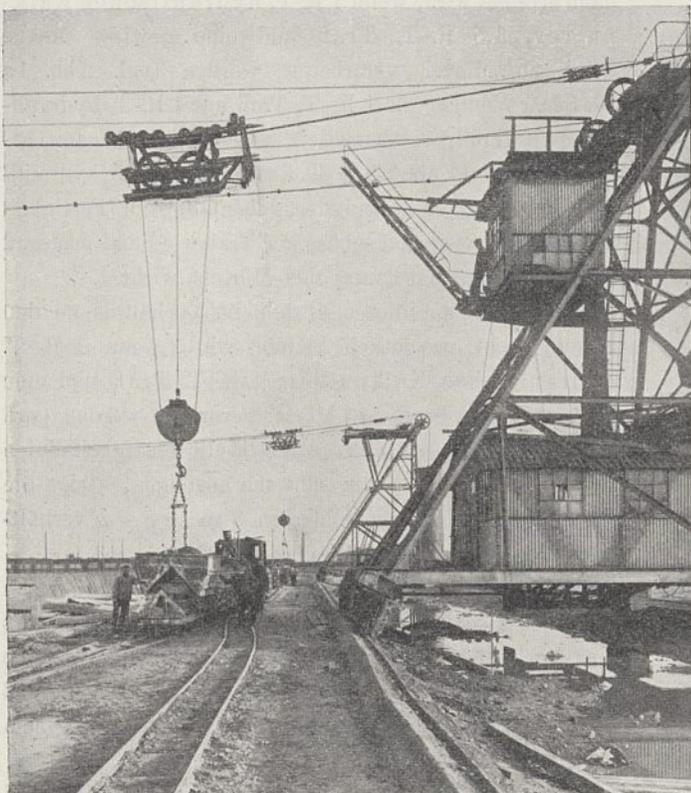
Abheben eines Betonkübels vom Unterwagen.
